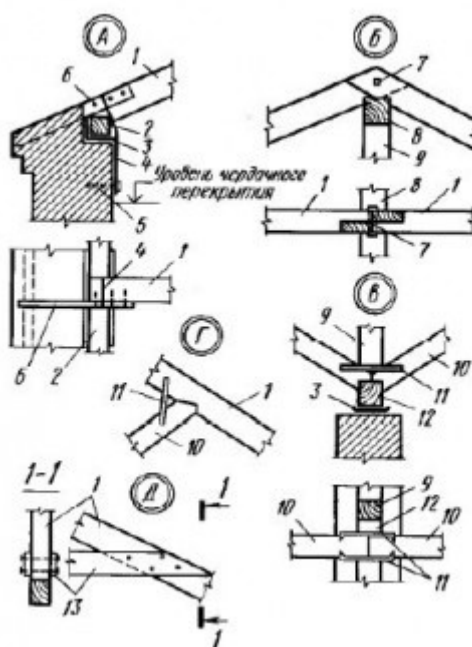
Детали узлов деревянных брусчатых наслонных стропил
